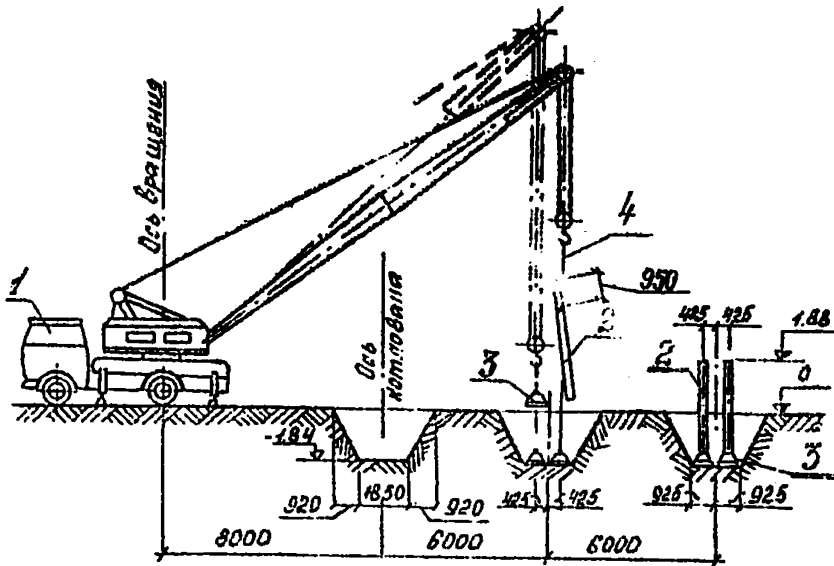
Разрез на стадии монтажа железобетонных конструкций краном СМК-10 (3 опоры УО-330-102):
